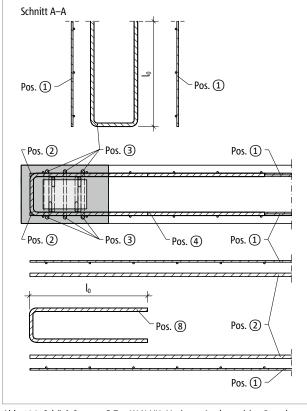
Schöck Sconnex® Typ W-N-VH: Variante A – bauseitige Bewehrung mit Pos. 4 für Anschluss am Wandende
